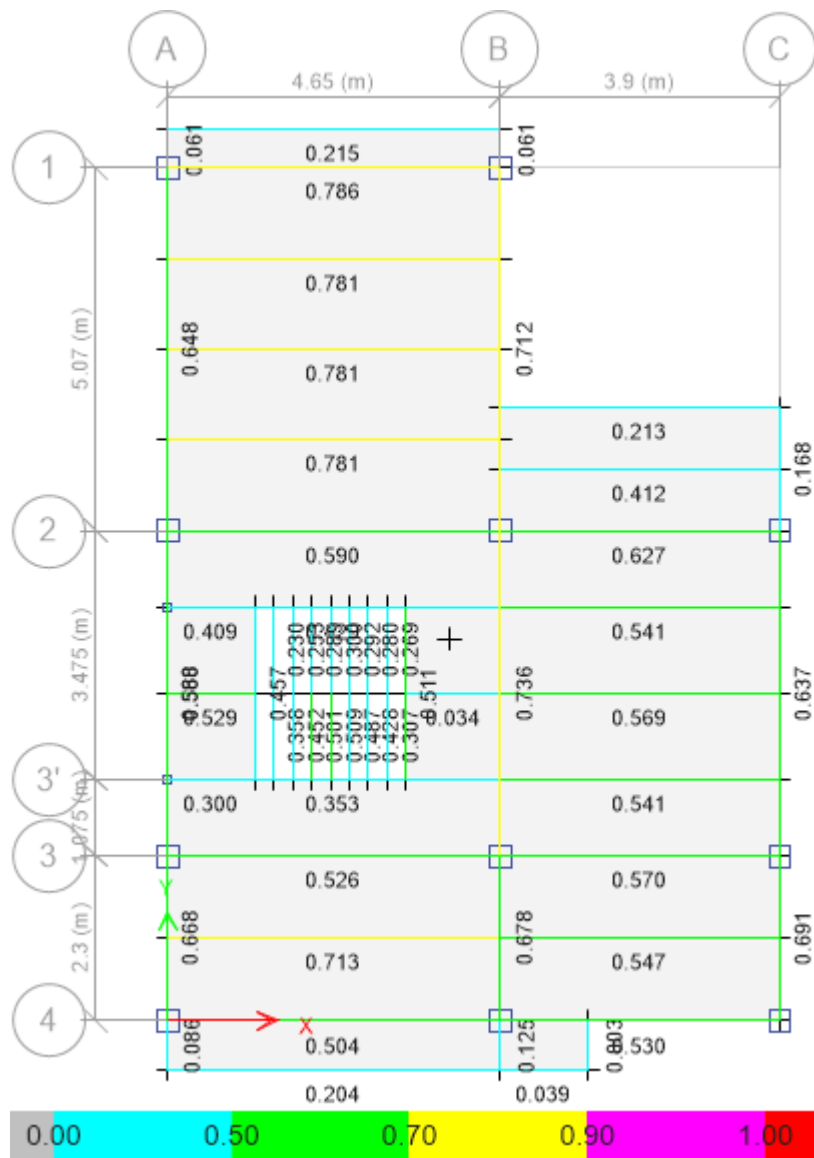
Diseño de vigas principales y secundarias de la losa del nivel +3.06, de la estructura con columnas de acero huecas
